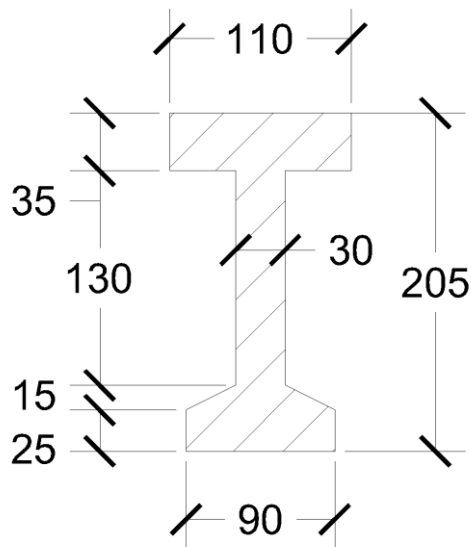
Seção transversal das vigas VP3, VP4 e VP5
